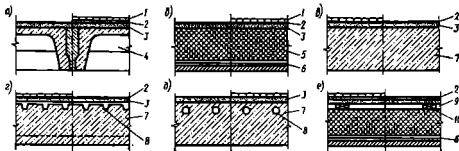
Основные типы покрытий с железобетонными плитами и рулонными кровлями:
